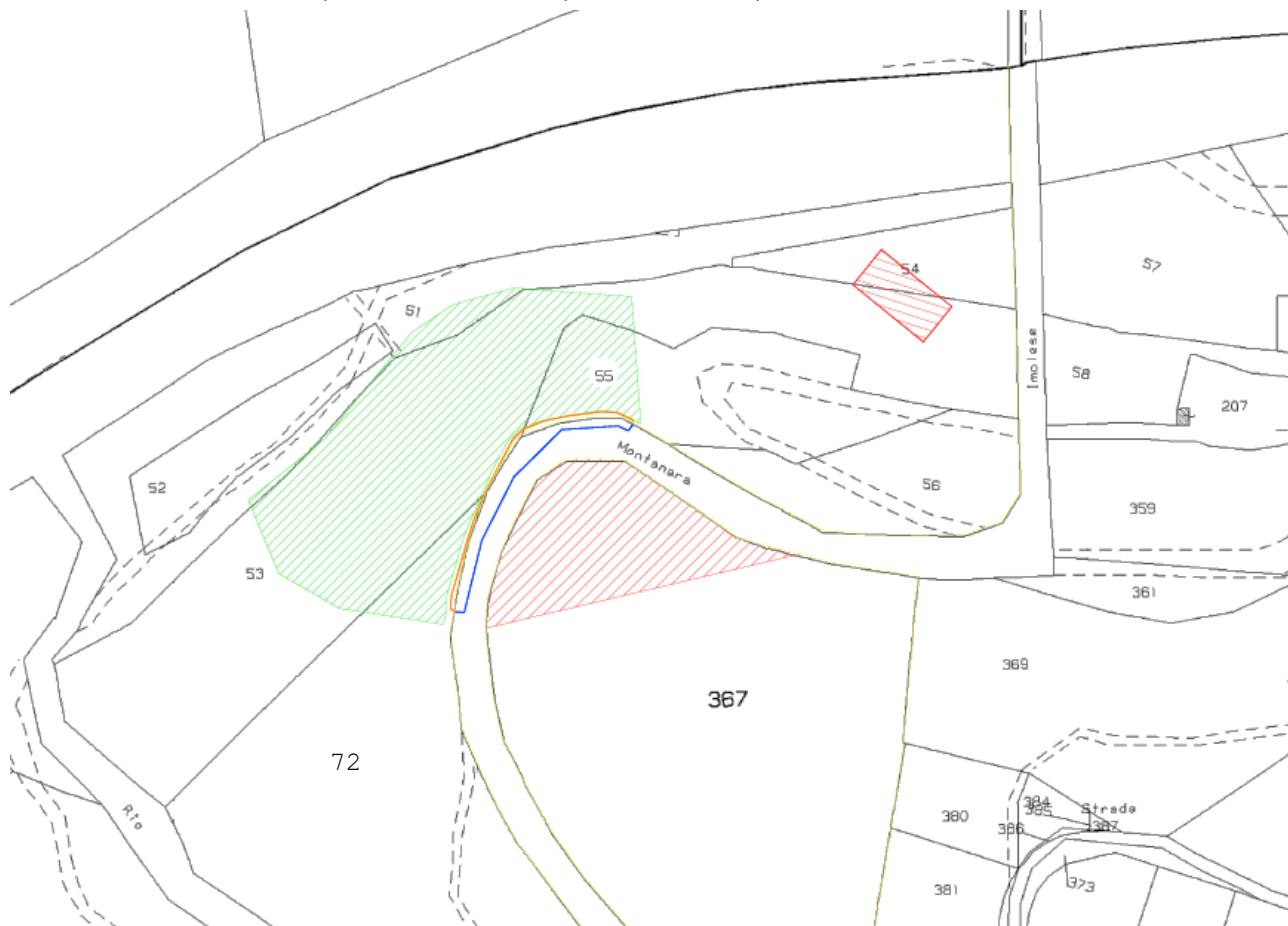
Estratto planimetrico con indicate le aree che saranno occupate dalle lavorazioni in progetto
